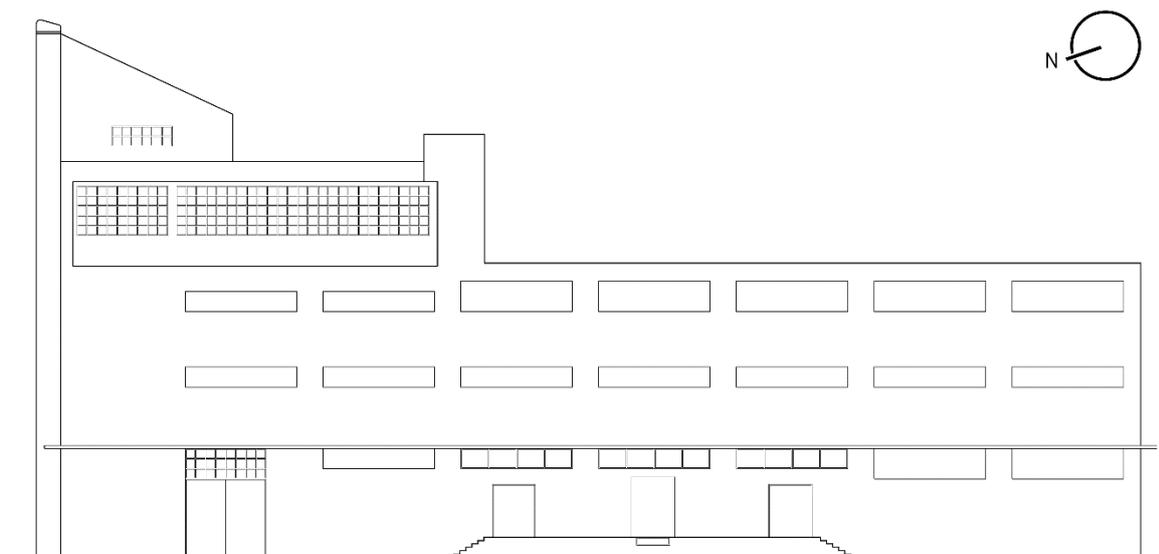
Esquema de la fachada noroeste nave principal en 1960 (nave I). Fuente: elaboración propia.
